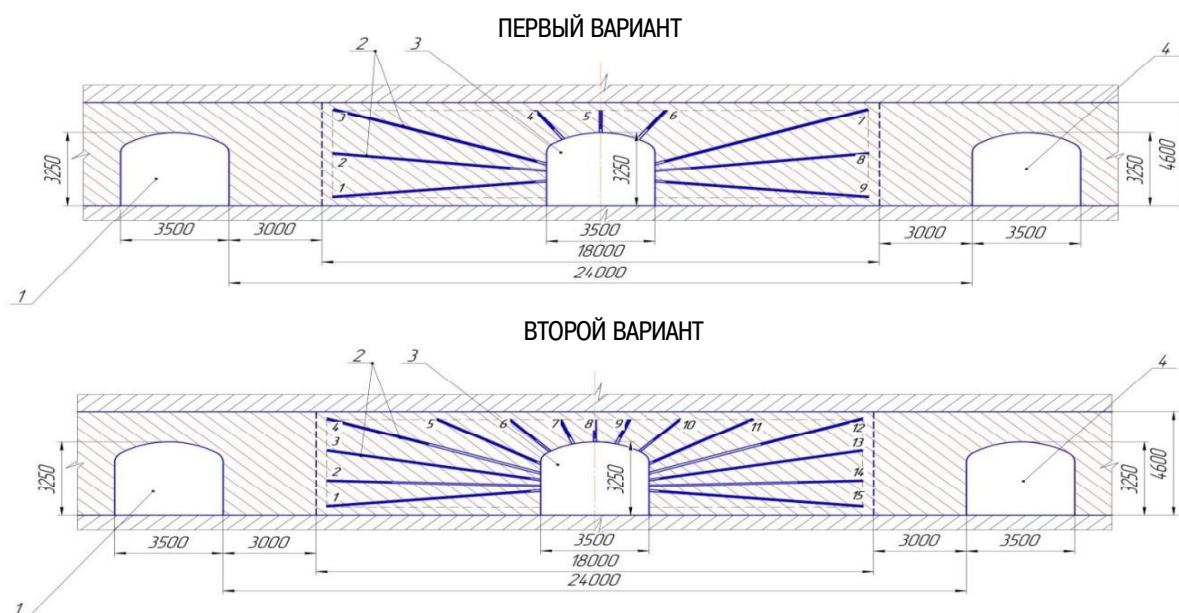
Схемы расположения взрывных скважин: 1 – вентиляционно-доставочный штрек № 1; 2 – взрывные скважины; 3 – вентиляционно-буровой штрек; 4 – вентиляционно-доставочный штрек № 4 / Fig. 7. Layout of blast holes: 1 – ventilation and hauling drift № 1; 2 – explosive well; 3 – ventilation-drilling drift; 4 – ventilation and hauling drift № 4
